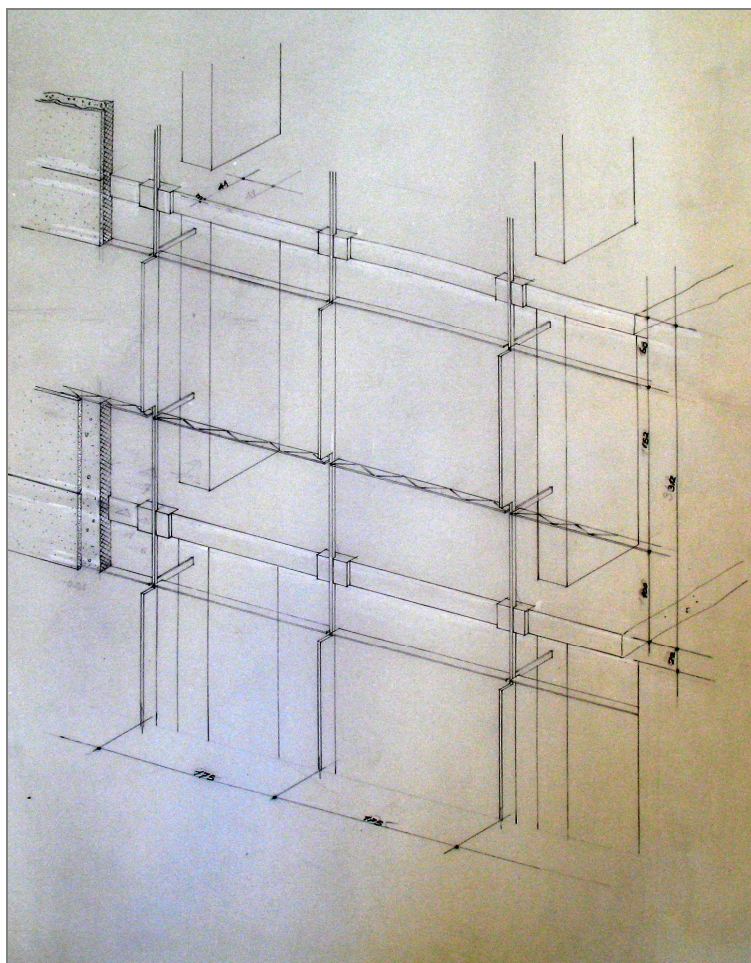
vista assonometrica pannelli di facciata (fonte CSAC – stralcio tav. 40, archivio n. 181-3)
